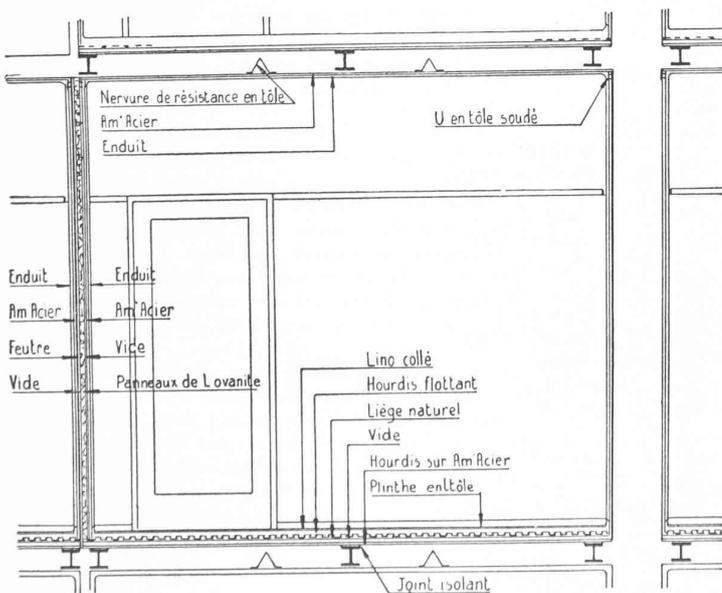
Coupe d'une pièce, montrant la constitution des planchers, des cloisons et du plafond flottant.
